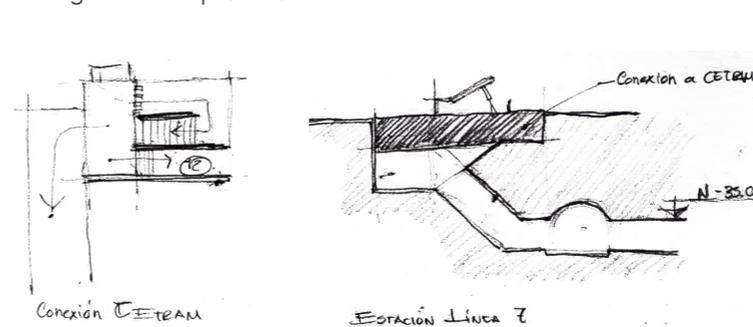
Planta y corte de funcionamiento de estación del metro Mixcoac Línea 7.
